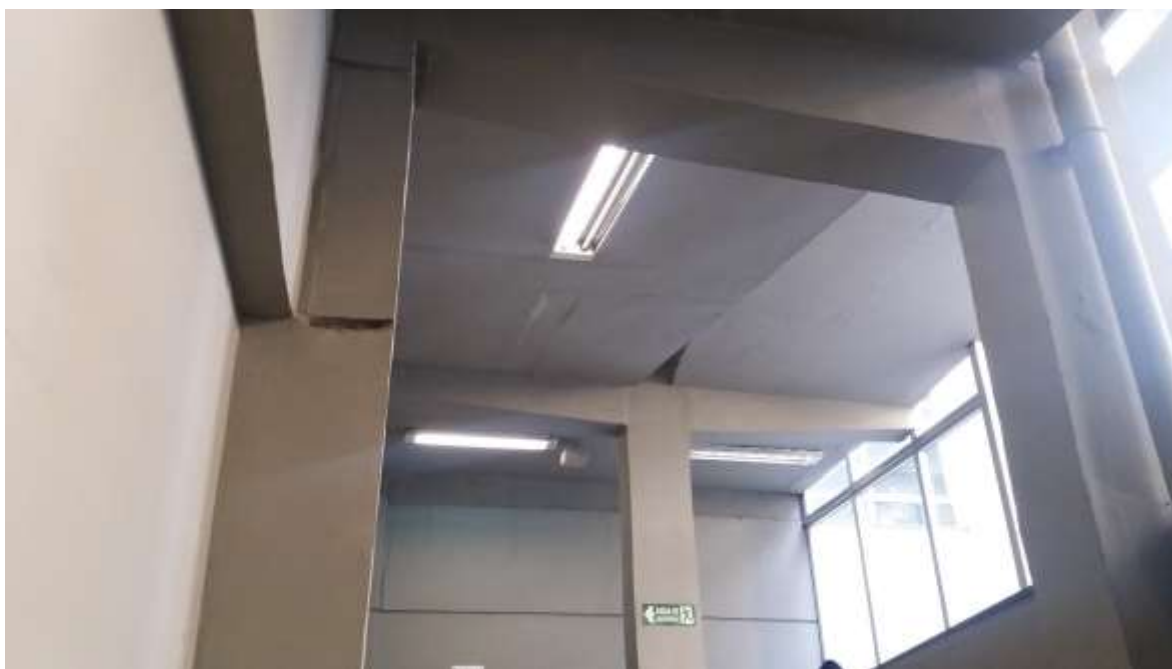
Encontro viga e pilar no INPS Várzea do Carmo
